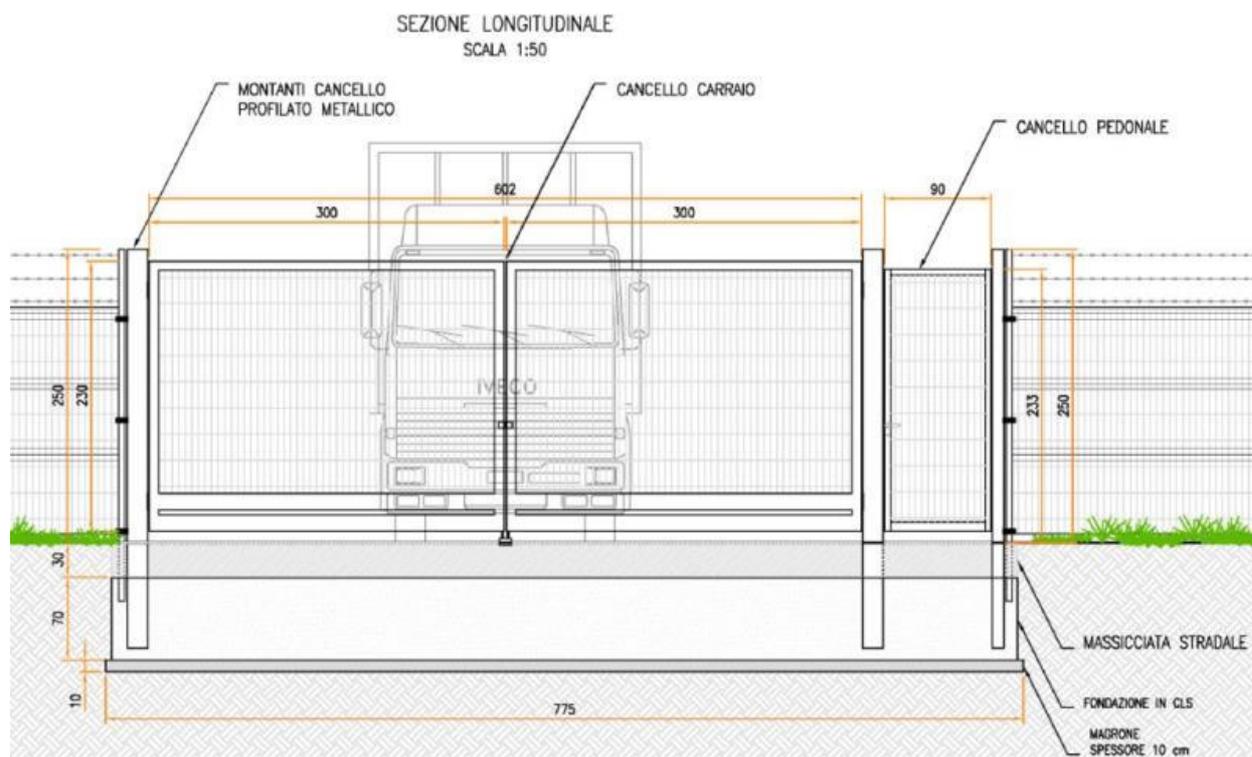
Sezione longitudinale accesso carraio e pedonale
